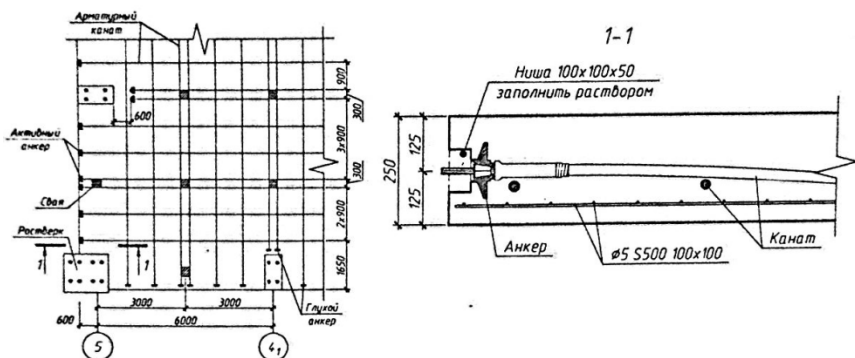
Пример решения предварительно напряженной фундаментной плиты [16]
